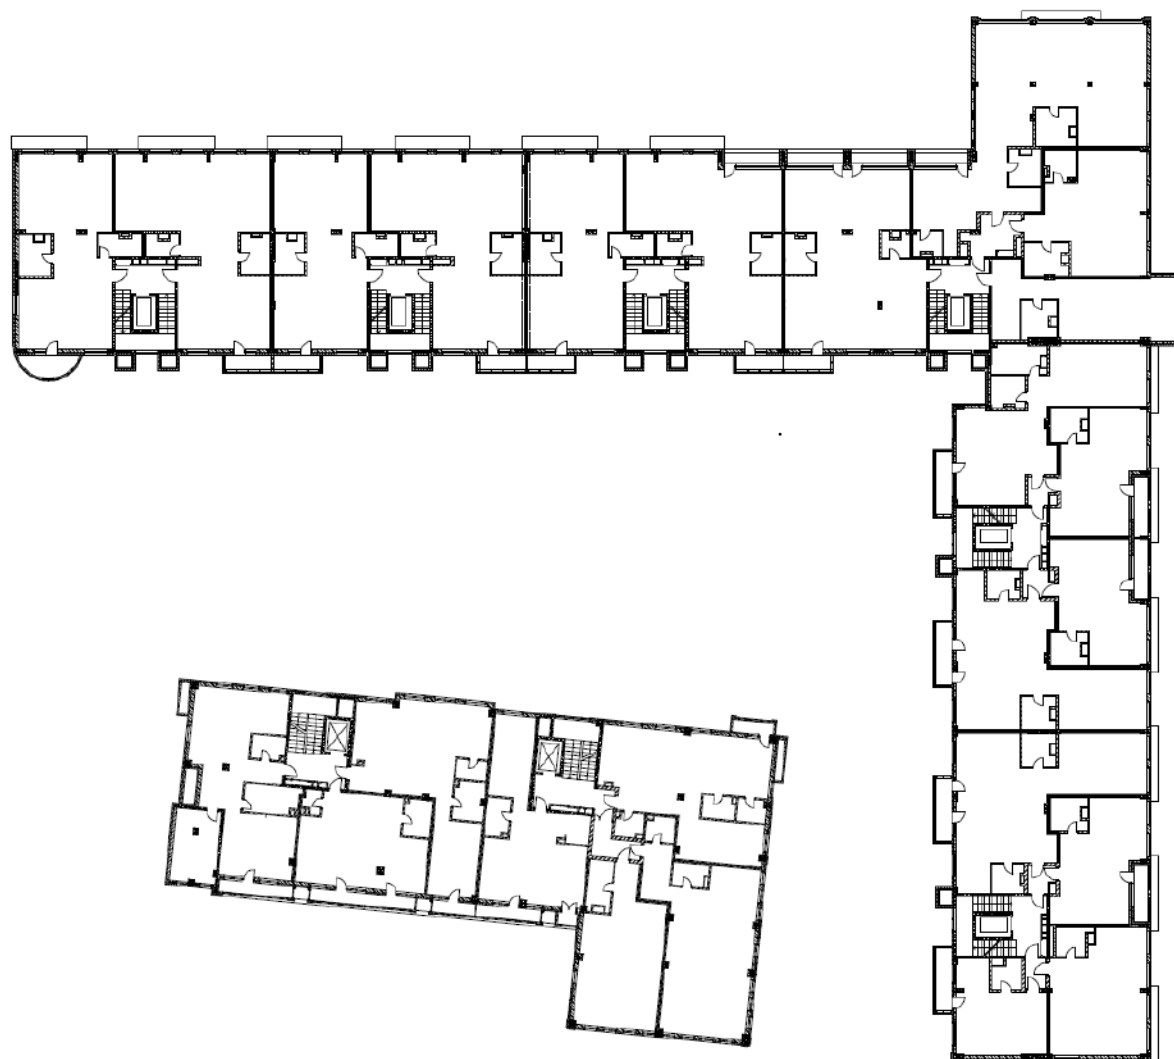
Жилой комплекс «Георгиевский». Схема плана жилого этажа.
